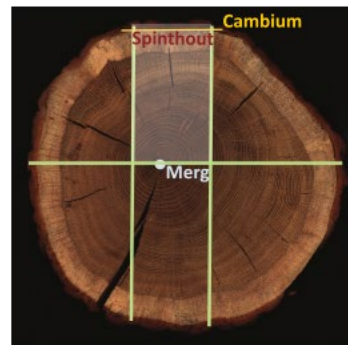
Twee, drie tot vierzijdig gerechte balk uit derde uit halve stam
